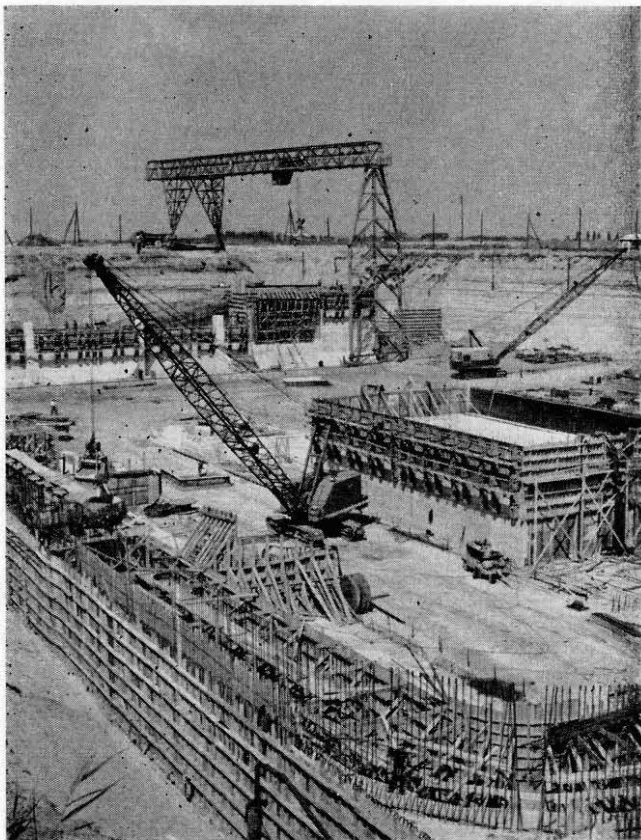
Fondation du mur de séparation entre les chambres latérales de portes de la tête aval. Ce mur en béton a 14 m. d'épaisseur à la base.
